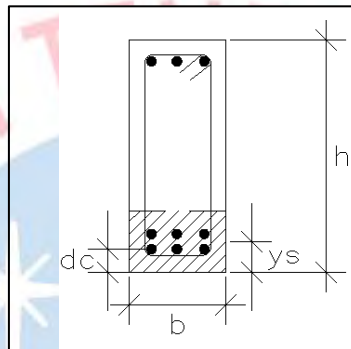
Control de fisuración (Norma E.060).
